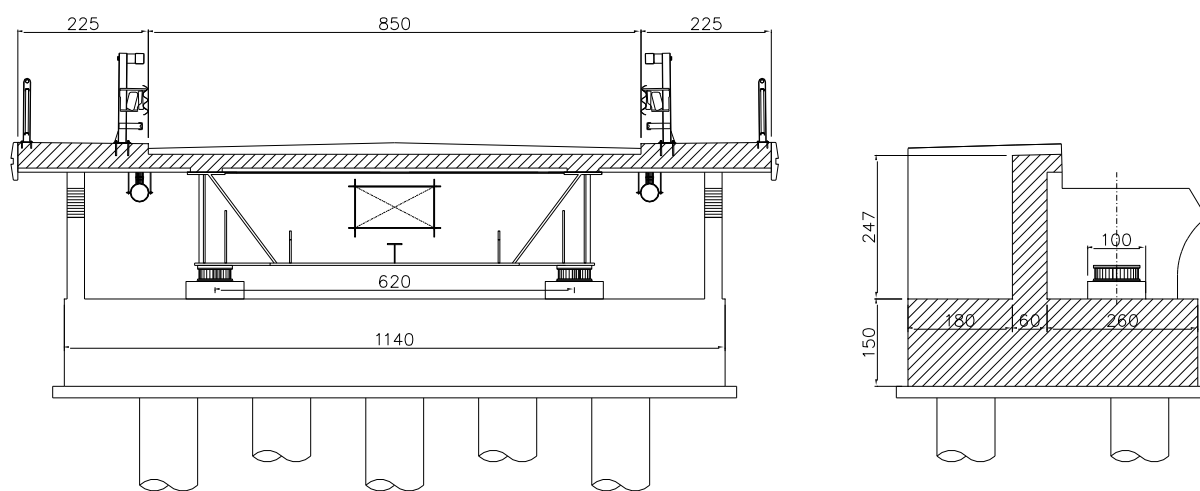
Prospetto frontale e sezione longitudinale della spalla
